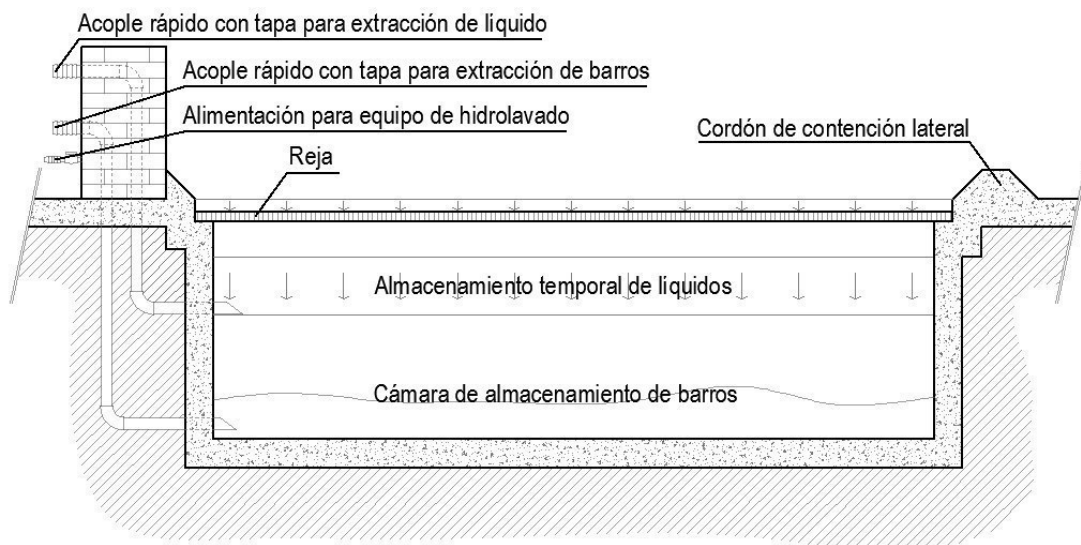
| Rampa con reja para lavado. Corte C-D.-
